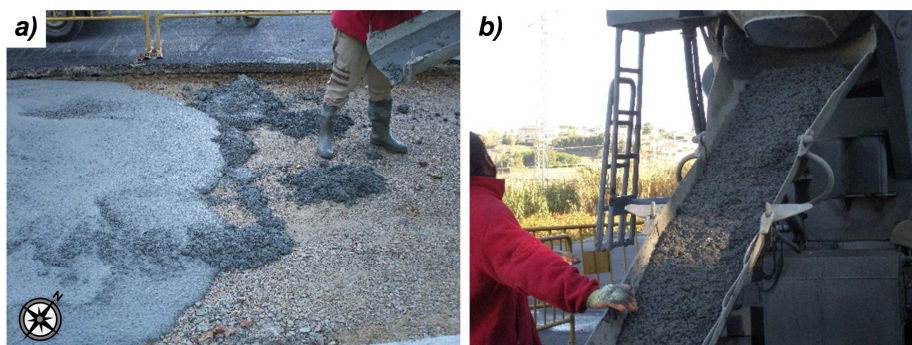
57 – a) puesta en obra y; b) proceso de hormigonado
